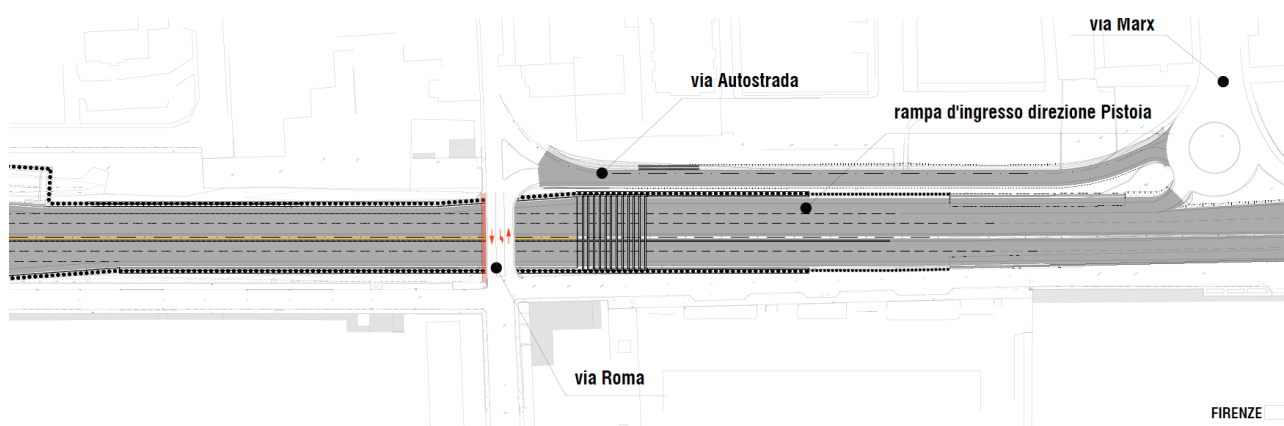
Stralcio planimetrico con indicazione della rampa d'ingresso direzione Pistoia
